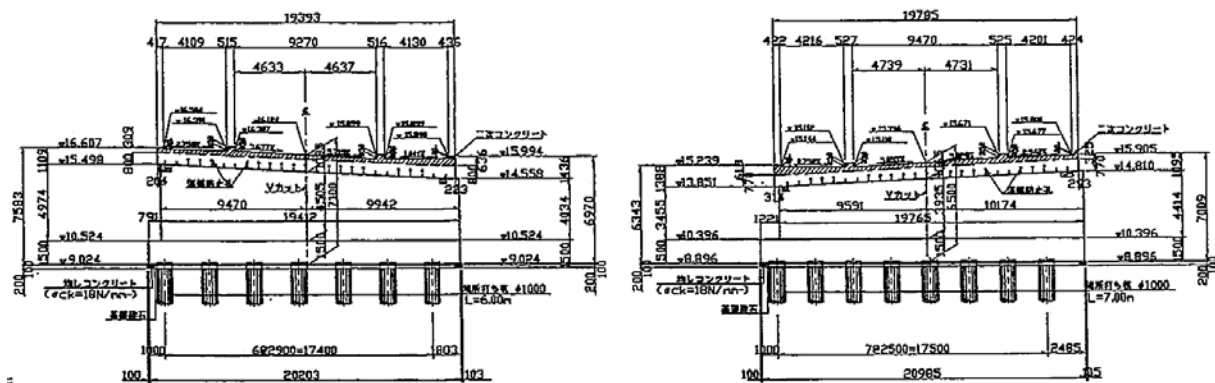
(2) 橋梁一般図(南沢川橋)
